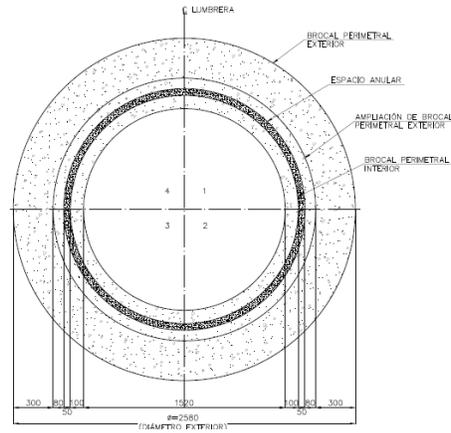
Vista en planta de la segunda etapa; definición de cuadrantes para arreglo de la extensión del brocal exterior.
